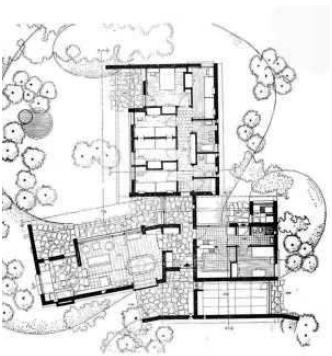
y 8 Fotografía exterior y planta de la Casa en Ofir, Fernando Távora, 1956-58
